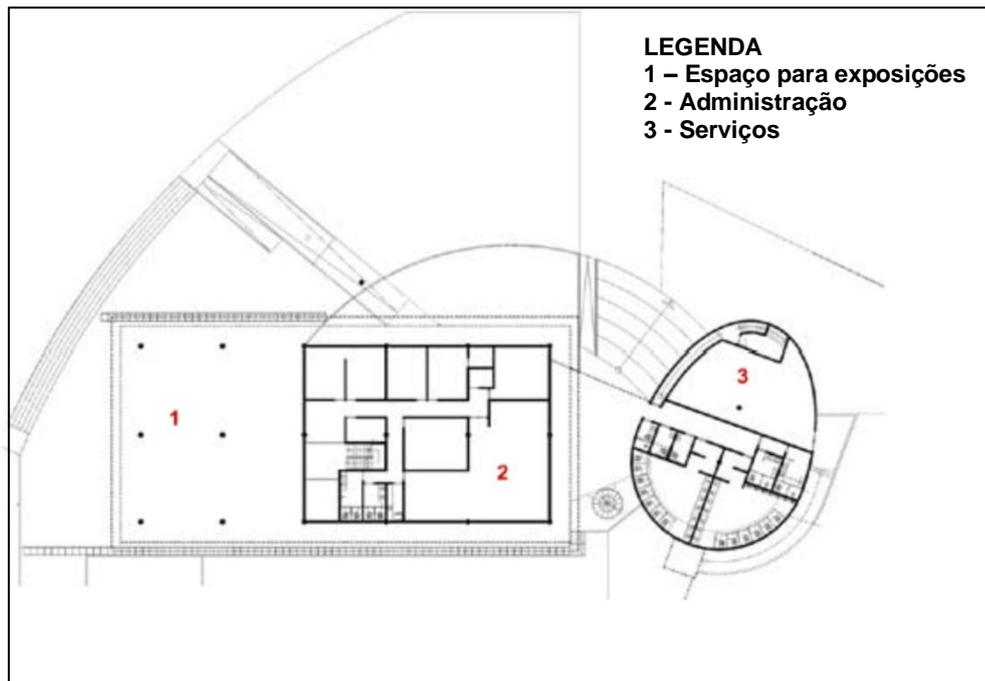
Pavimento Semi-enterrado – Edifício Educacional/ auditório
